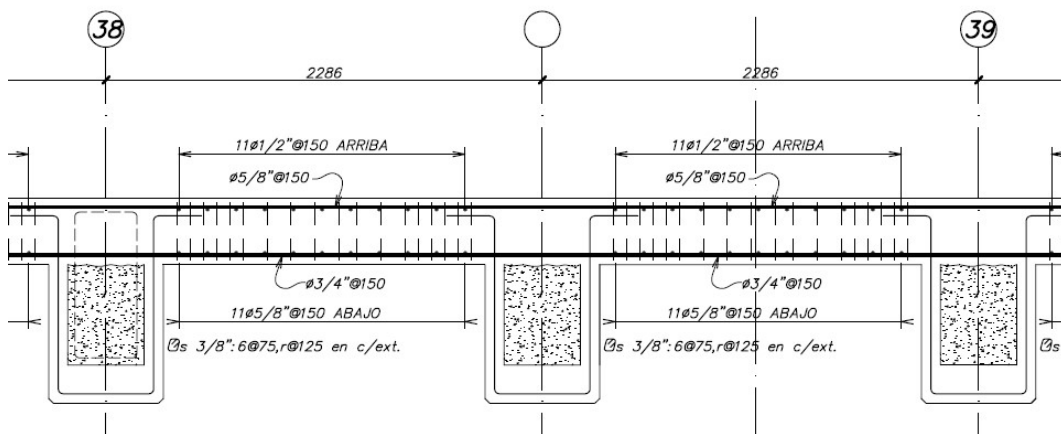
Armadura típica de losa de amarraderos 3A, 3B y 3C – Sección Transversal
